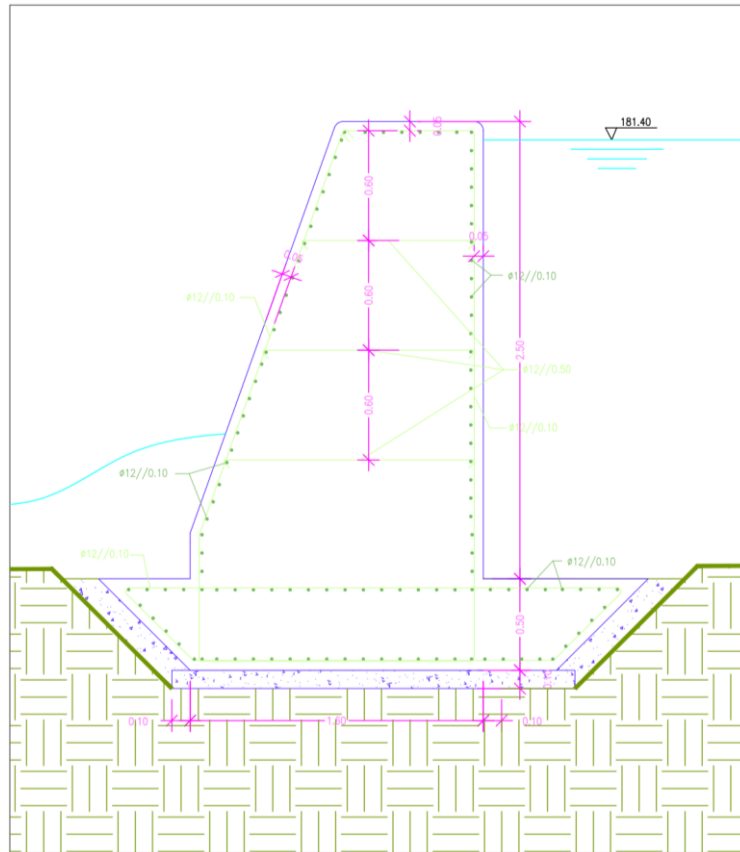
Corte B-B. Estrutura de retenção da bacia a Jusante. Fonte: Projegui.
